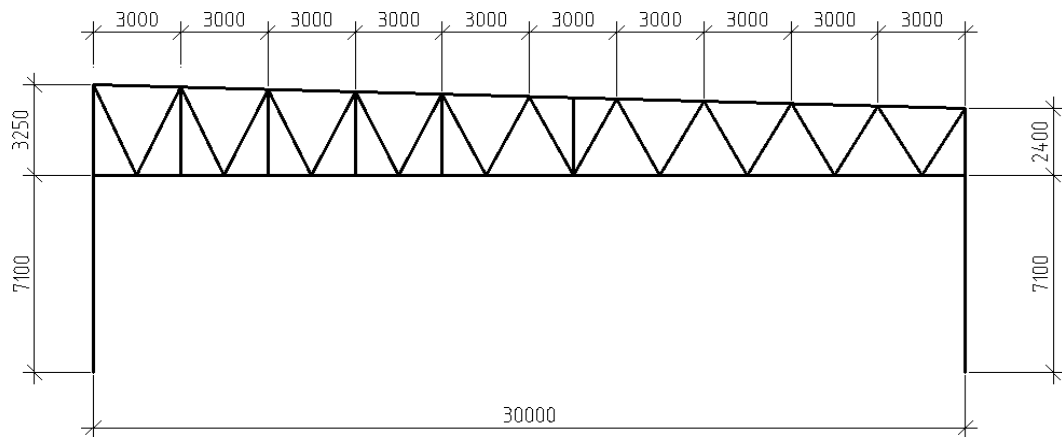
Завдання розрахункової схеми в AutoCAD
